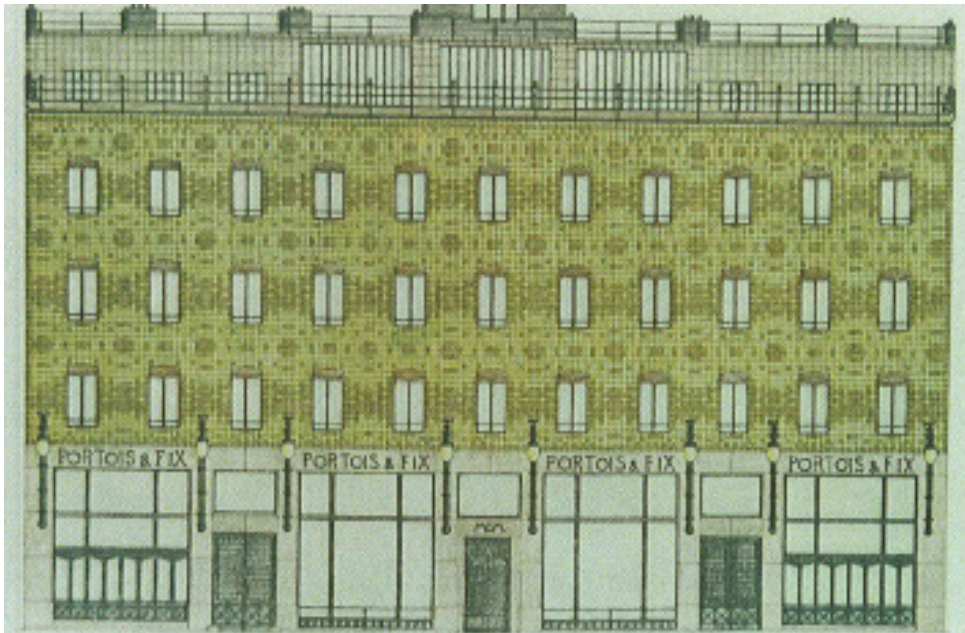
Fassadengestaltung Geschäftsgebäude Portois & Fix.
